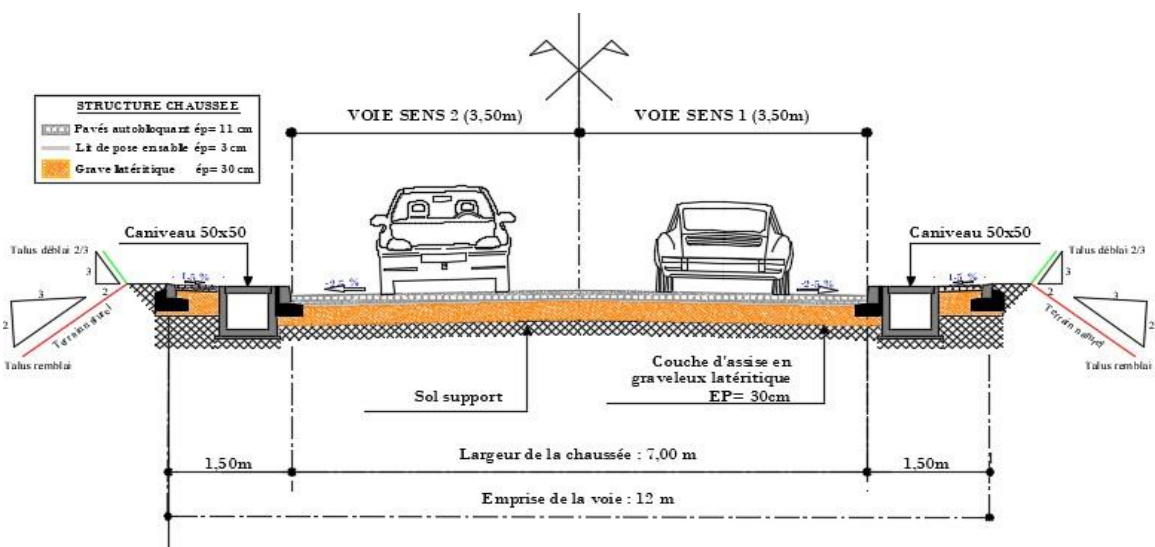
Profil en travers type pour la deuxième bretelle (chaussée de 7,00 m)
